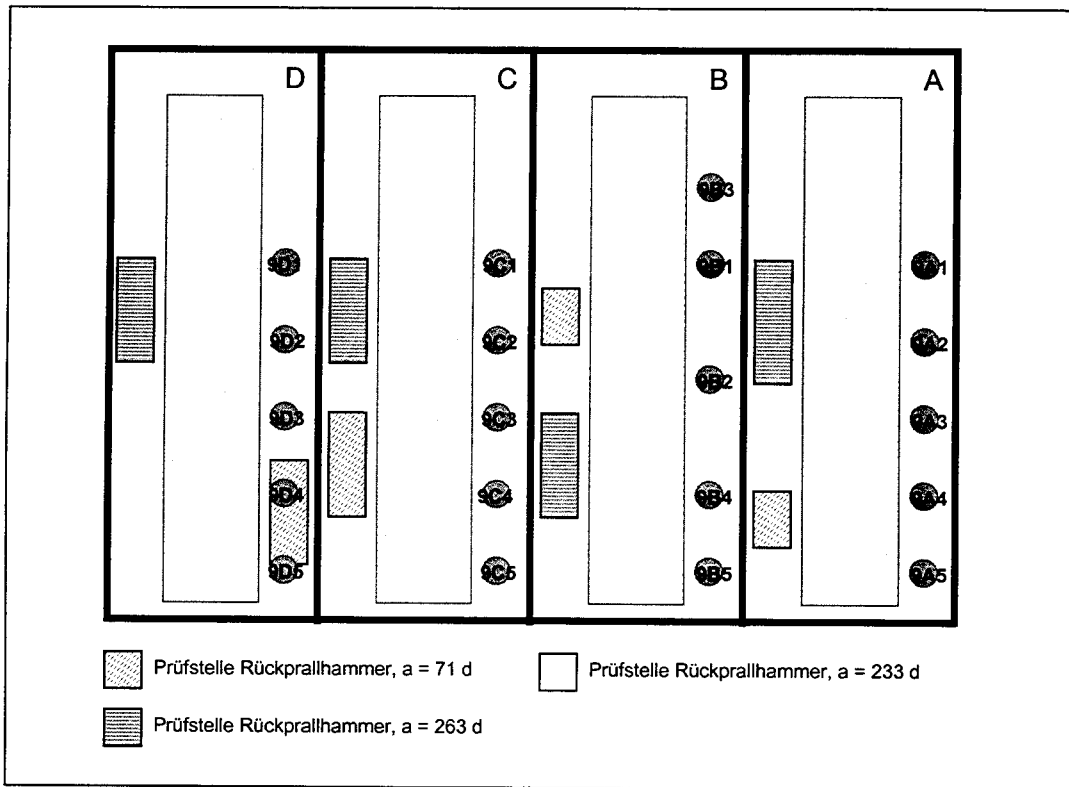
Lage der Prüfflächen am Betonkörper 6
